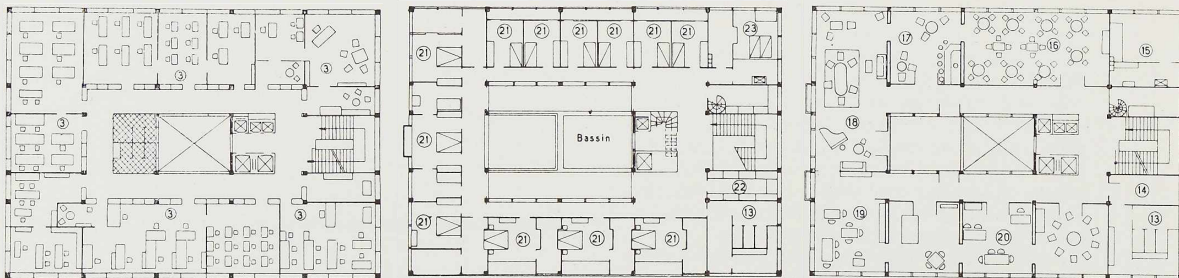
à 260. Plan d'un étage type et des deux derniers étages de la tour (club privé).
